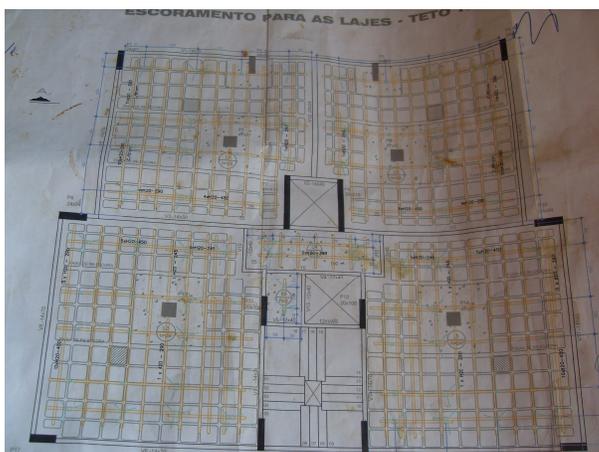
Projeto de escoramento das lajes. Fonte: Jorge Souza
